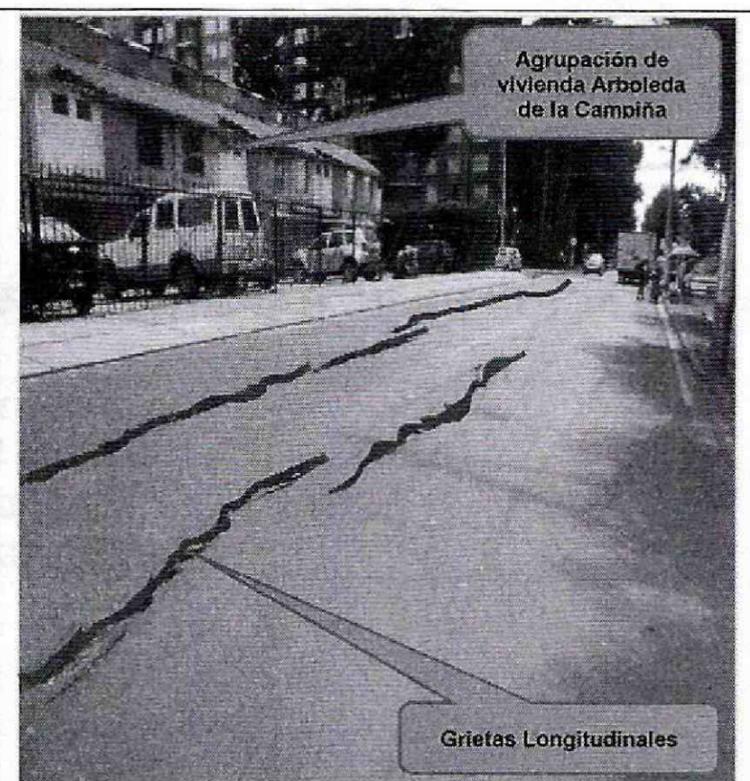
Detalle grietas longitudinales de la Carrera. 103B de entre calle 150ª y 150C
